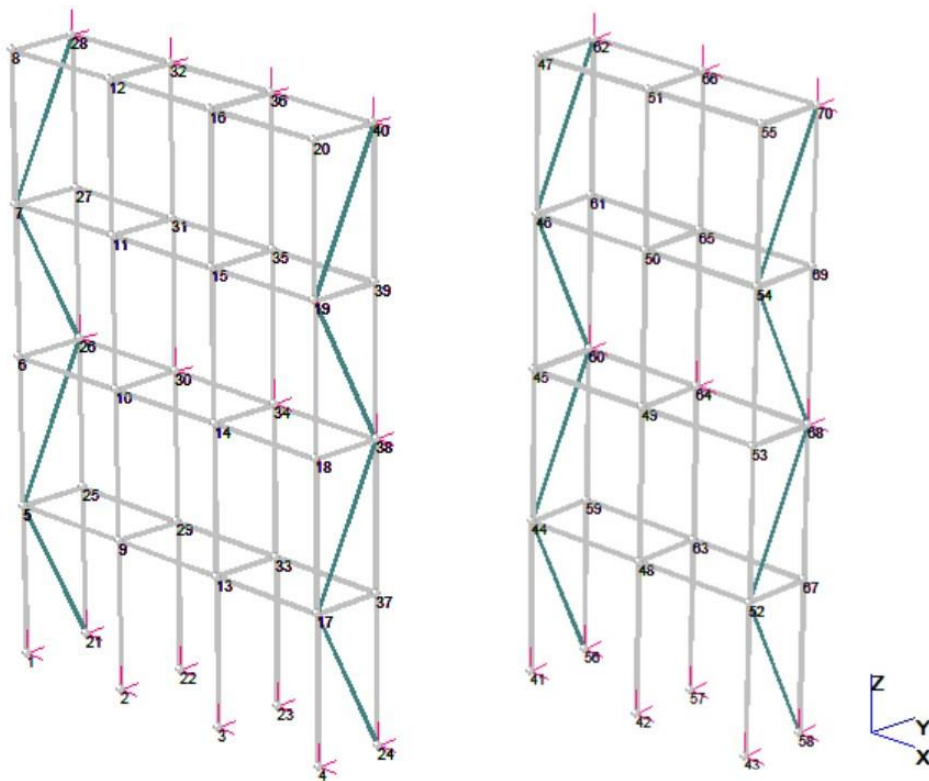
Sistema di controventamento laterale – Schema 1 Ponteggio 1
